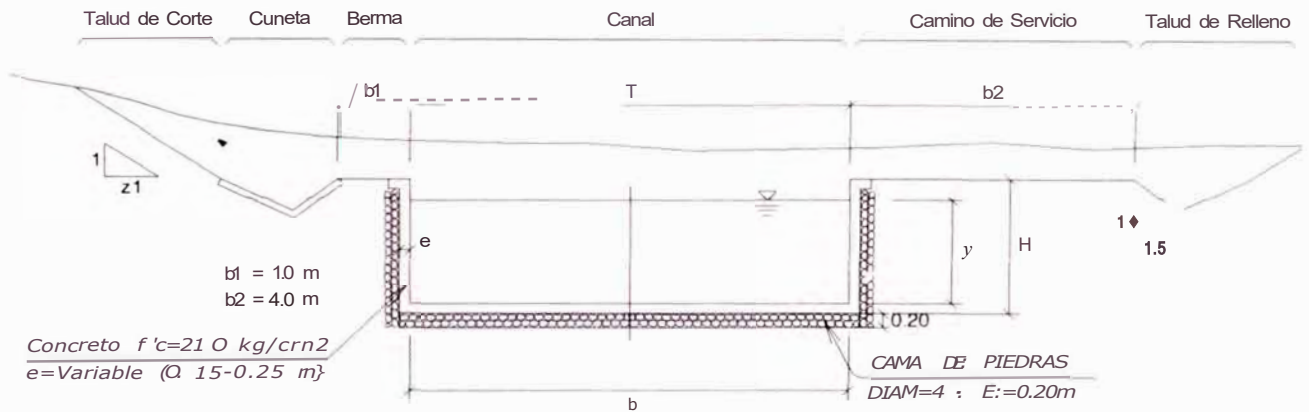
Sección Típica de Cama de Piedras en Corte del Terreno en el Canal Rectangular
